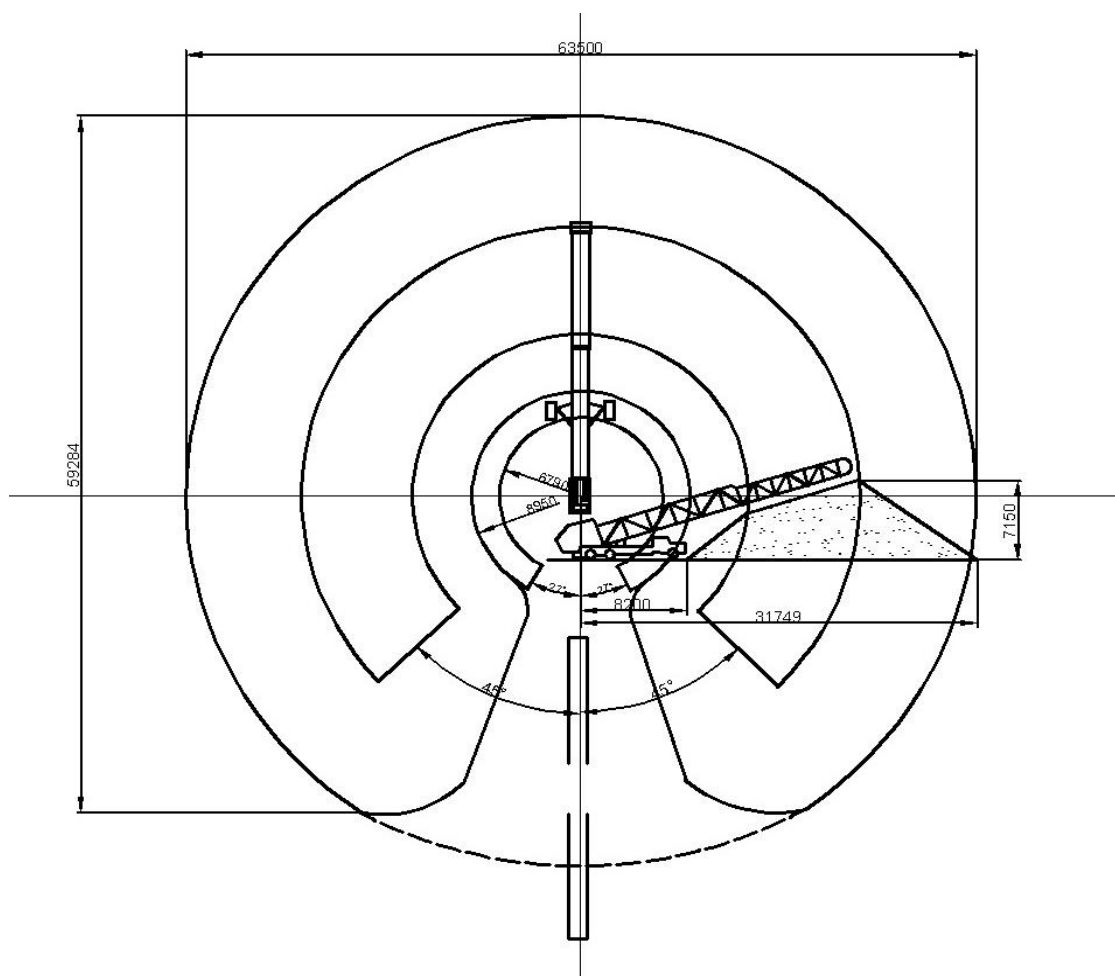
Параметры укладки штабеля радиальным штабелеукладчиком
